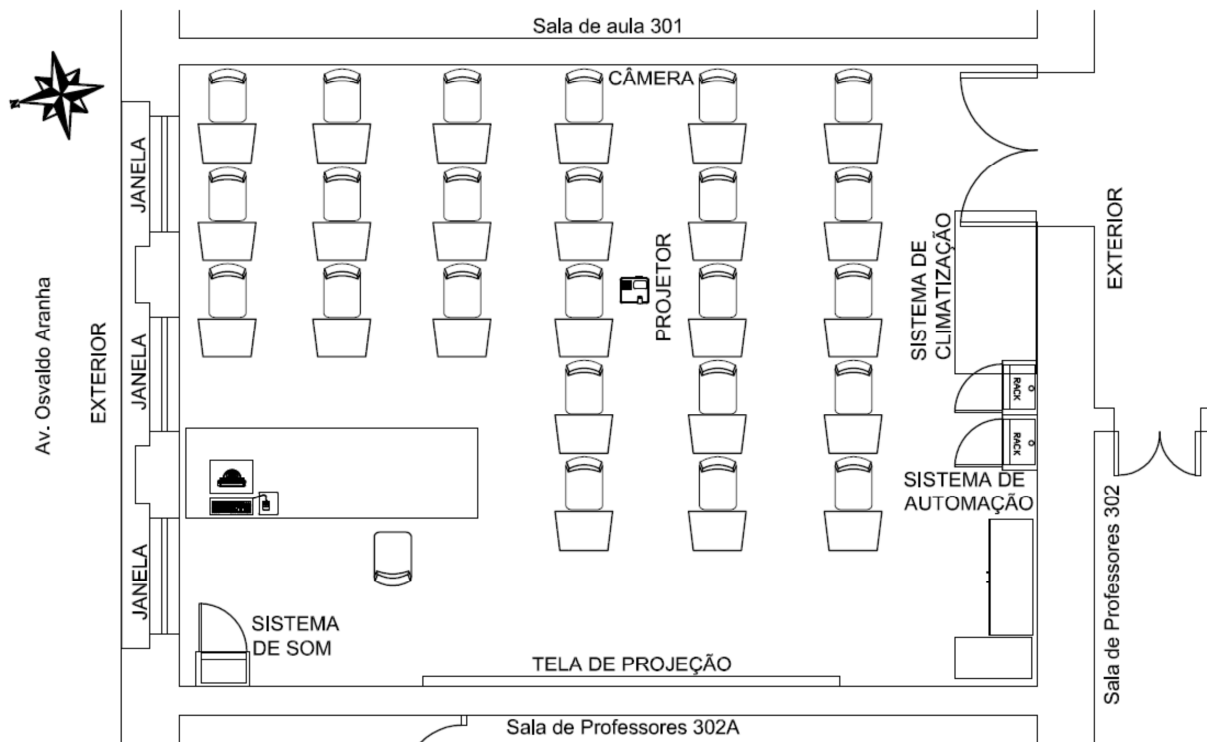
Planta Baixa da sala de aula ambiente de estudo de caso.
